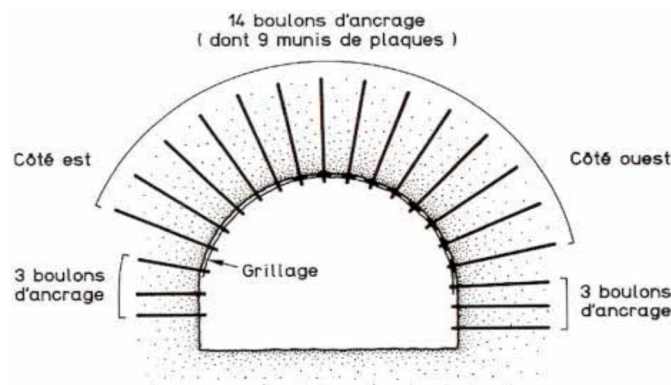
Soutènement par boulonnage. Section type d'une couronne.
